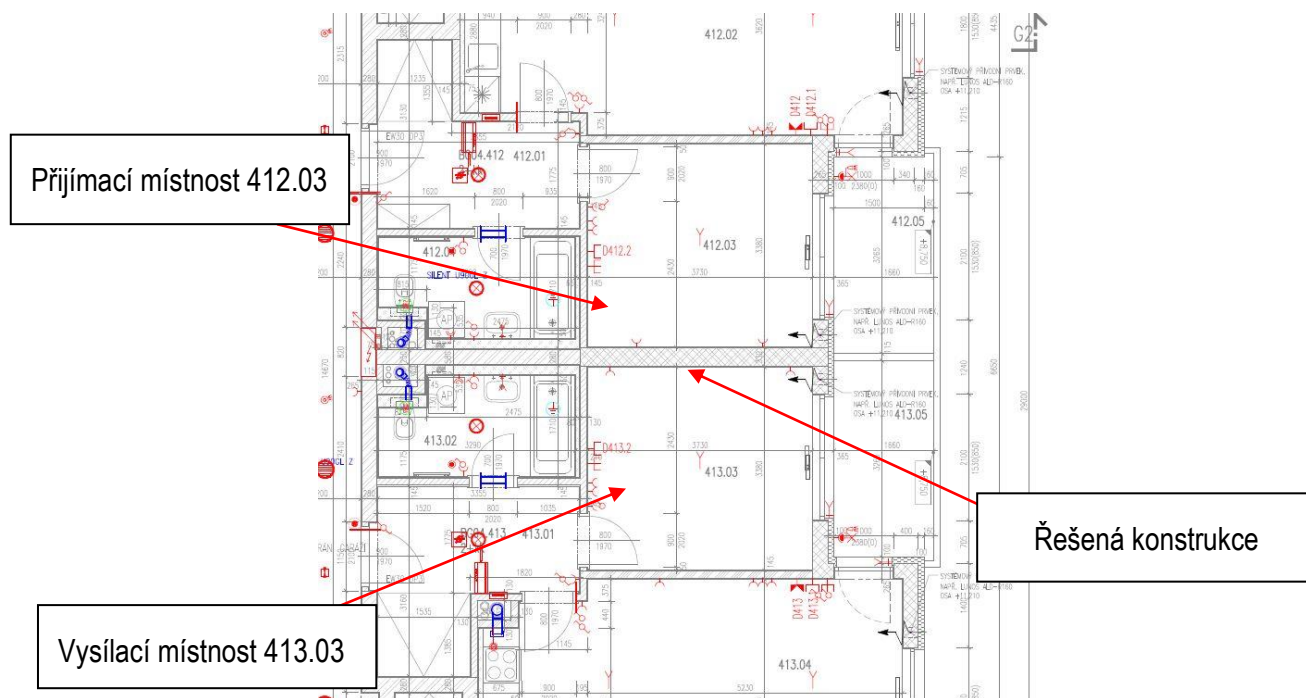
Schéma měření – část půdorysu 2.NP objektu G – železobetonová stěna
